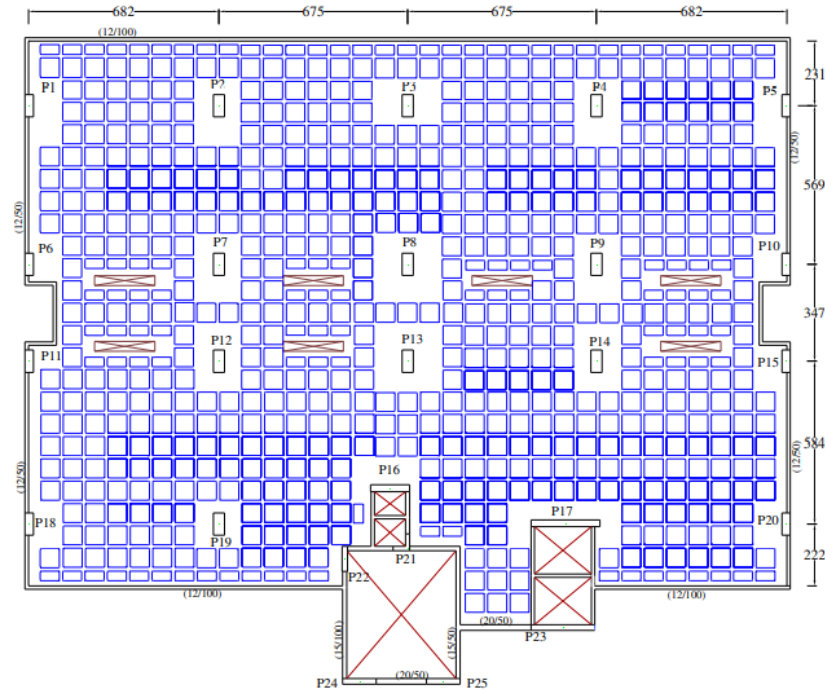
Planta baixa do pavimento tipo do primeiro exemplo analisado (DUMARESQ, 2008) – cotas em cm
